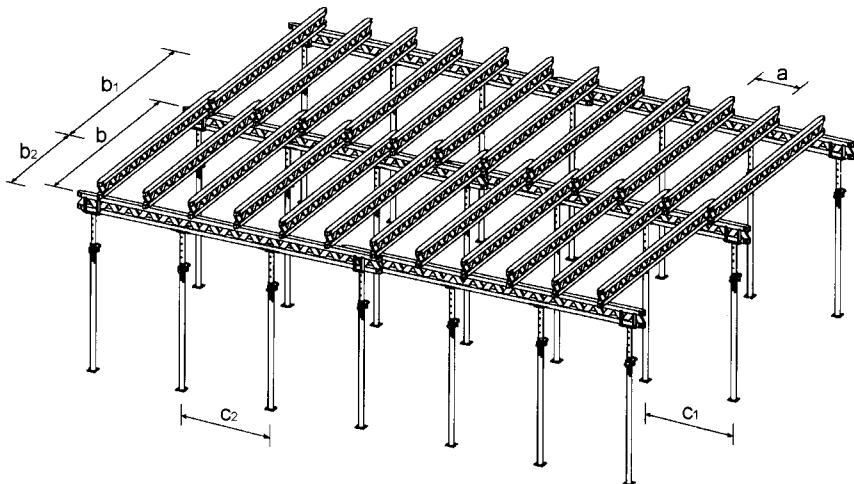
Расчетная схема опалубки MULTIFLEX:
